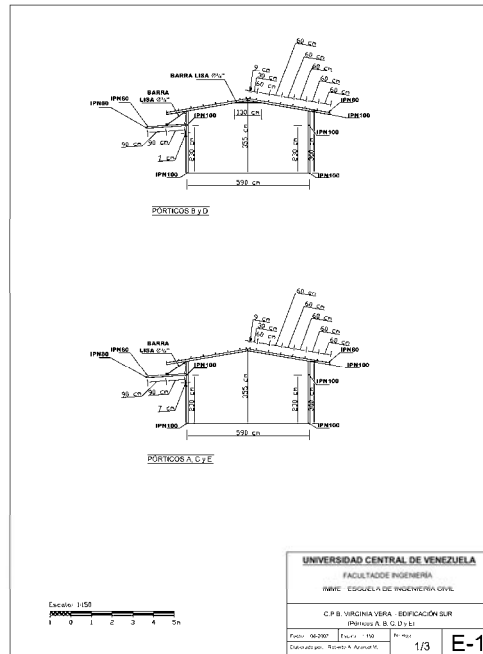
Plano E1: Plano Estructural de los pórticos A, B, C, D y E
